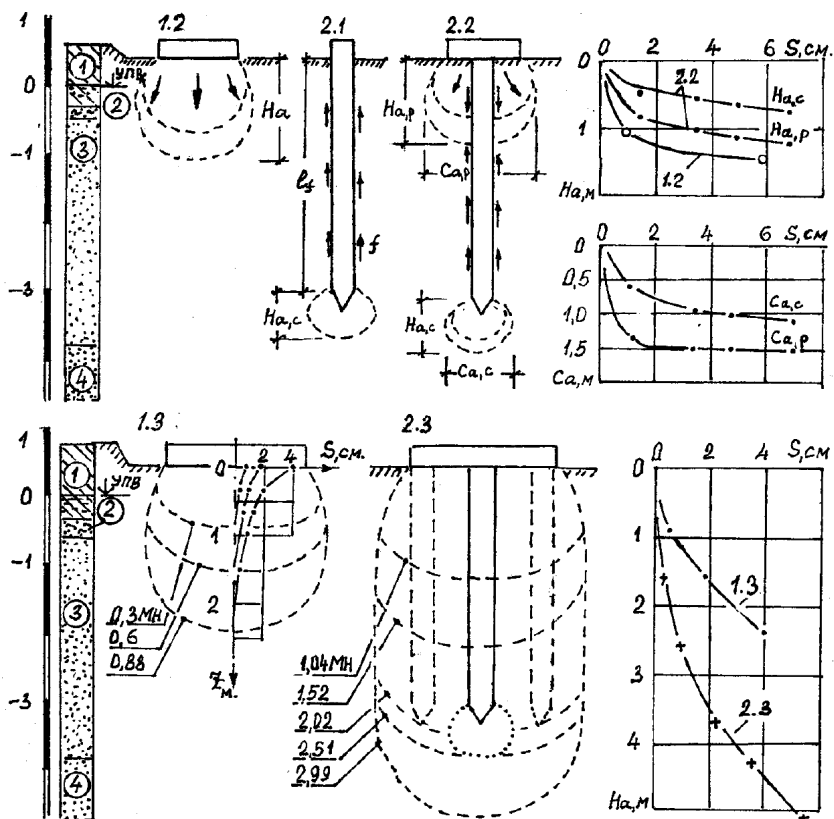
Нарастание границ зоны деформации в основаниях фундаментов свай и свайных фундаментов
